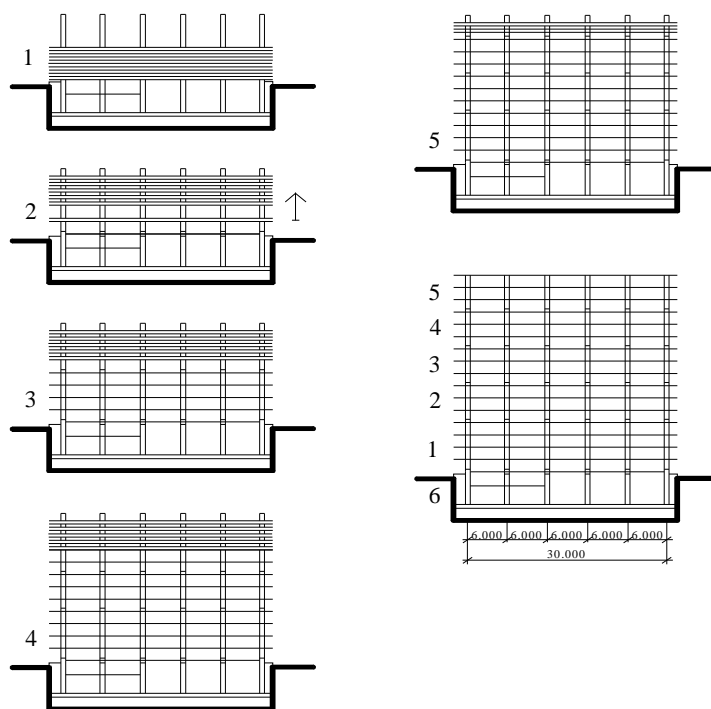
Схема монтажу будинку методом підйому перекриттів:
